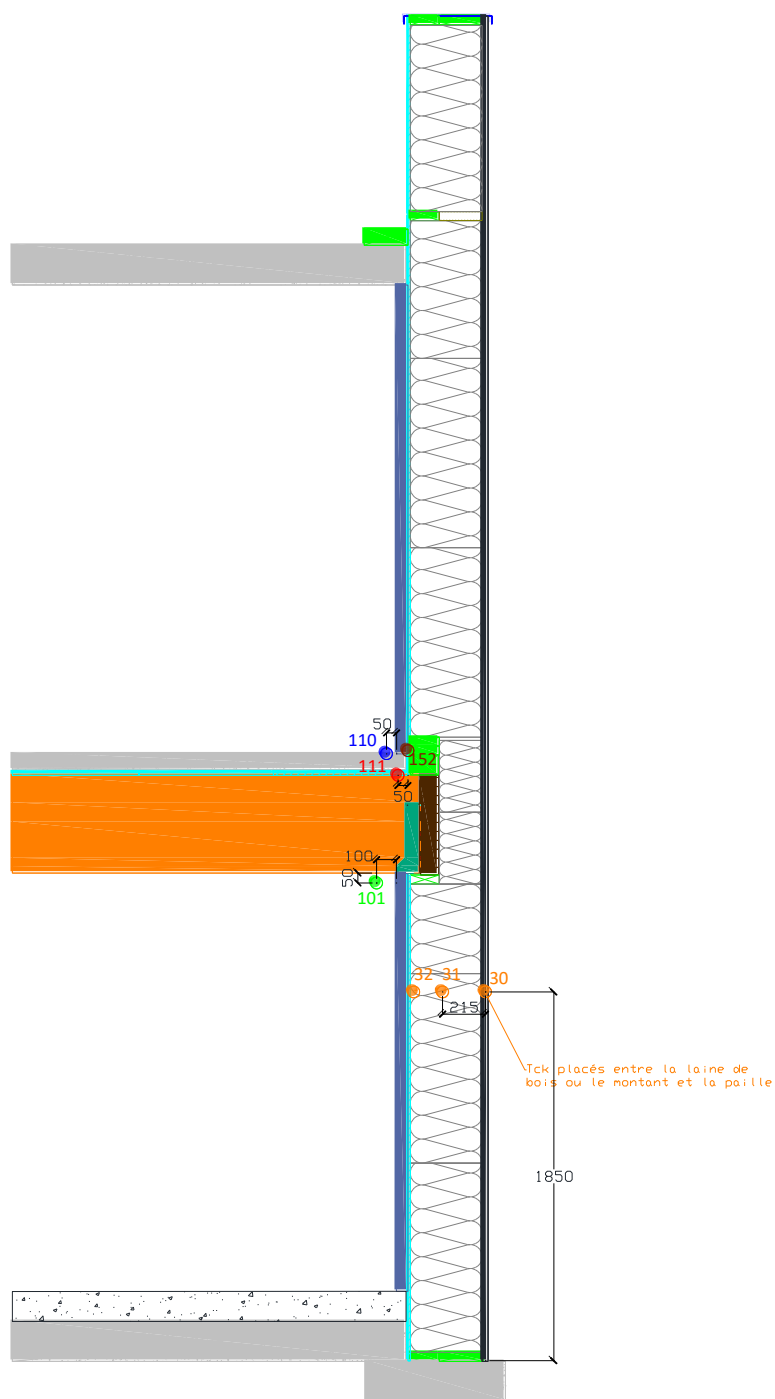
Instrumentation de l'élément de façade - Coupe K-K
